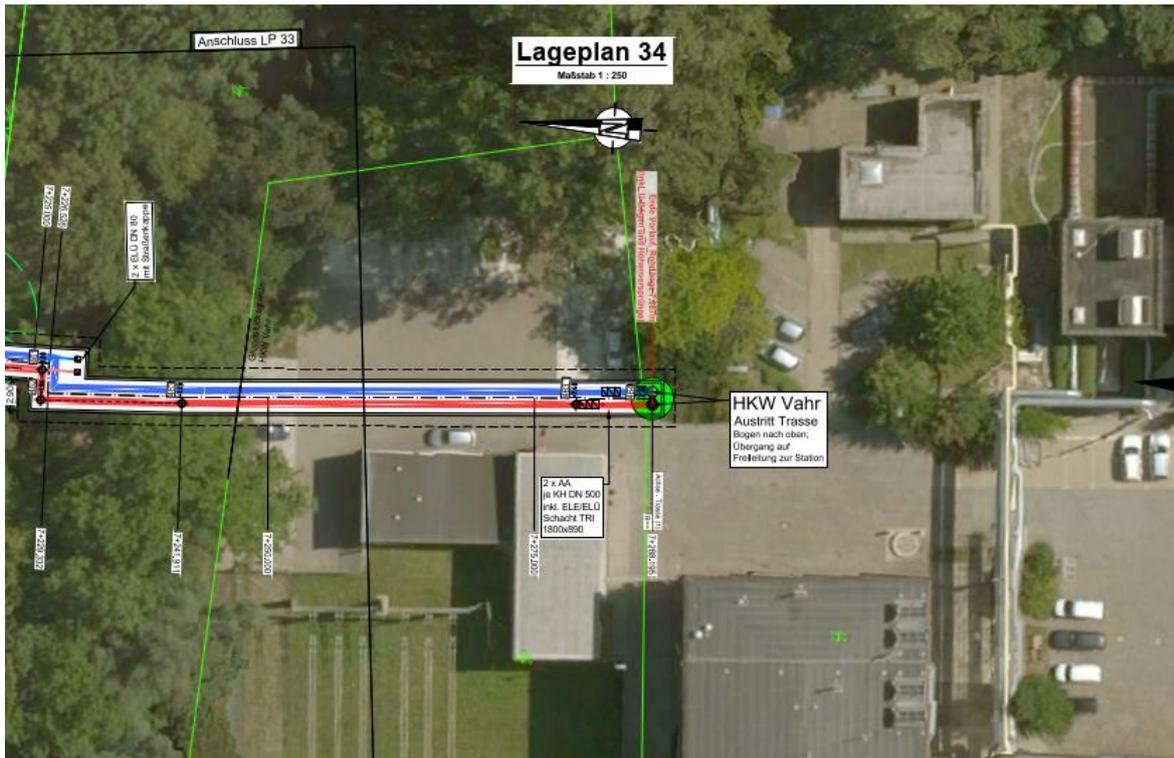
Abschnitt 16 – Gelände Heizwerk Vahr Plan 2.2.34
